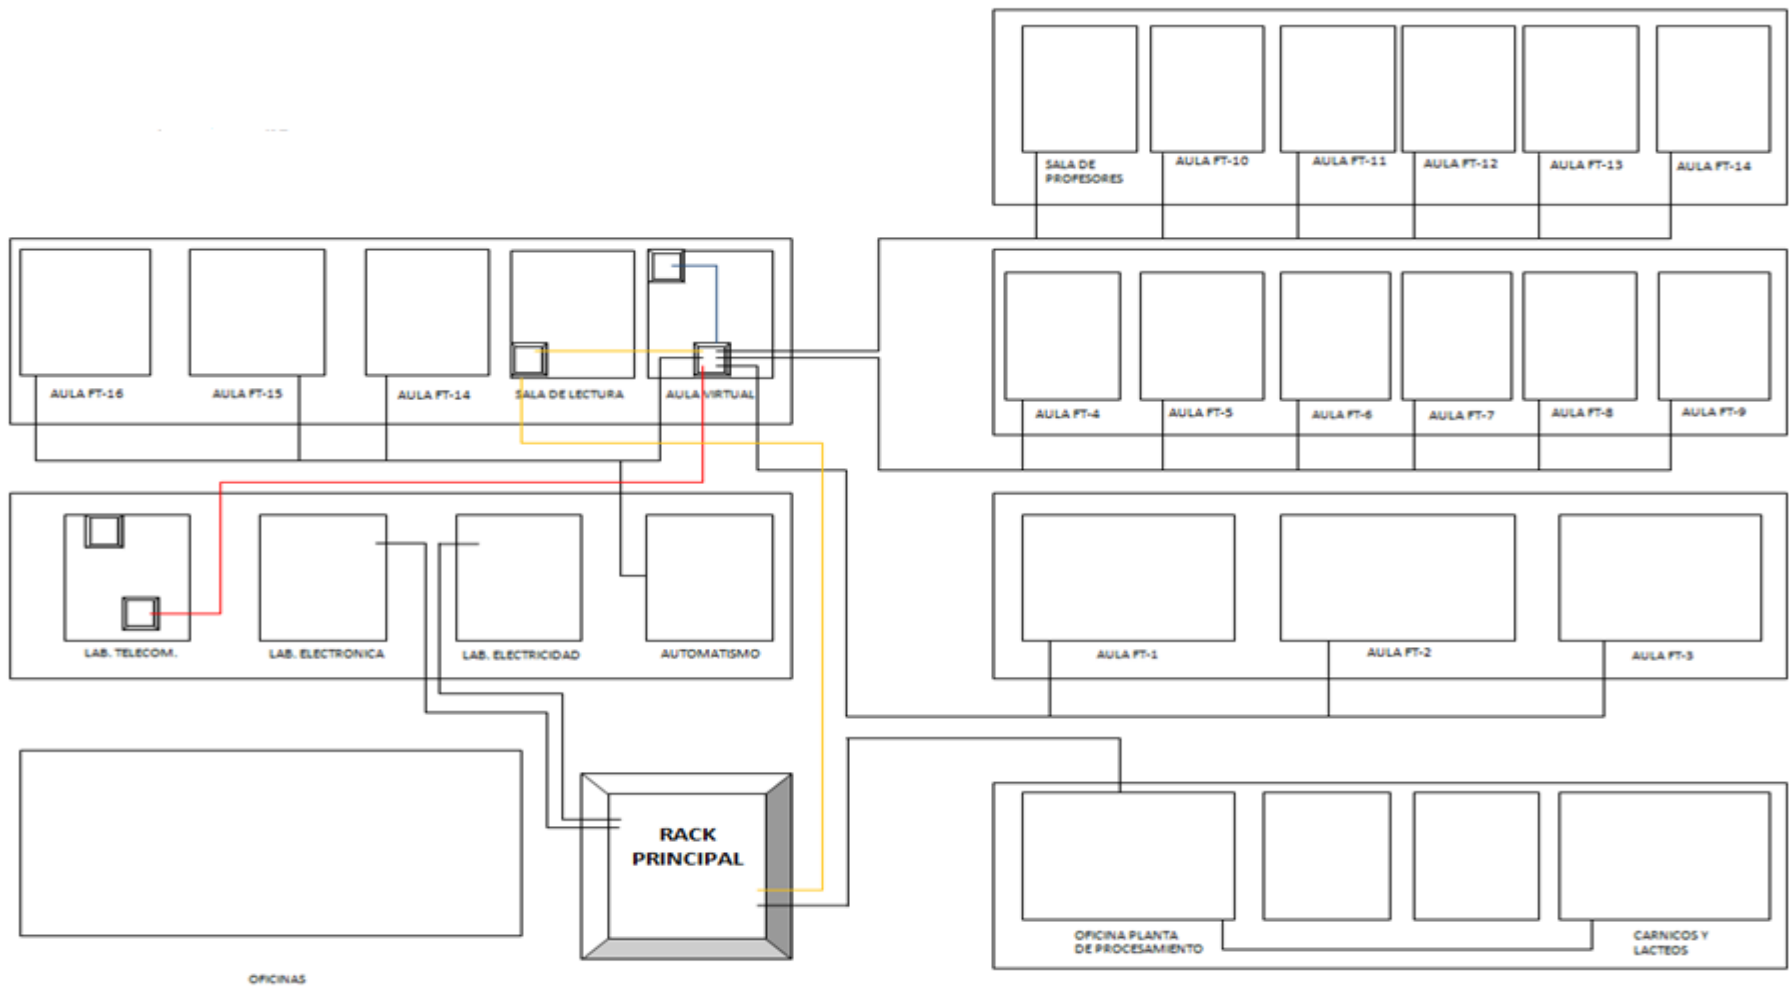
Cableado estructurado de la Facultad Técnica
